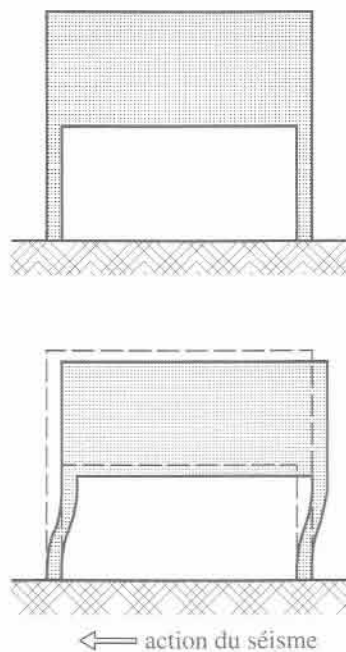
Portique au rez-de-chaussée et murs à l'étage
